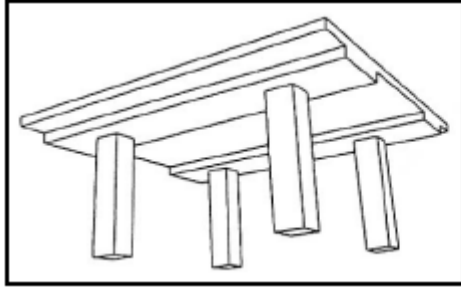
j. Diseño de losa de vigas planas en una dirección. [A3]
